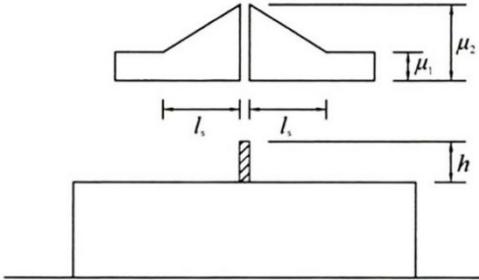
屋面凸起物引起的局部雪荷载示意图
